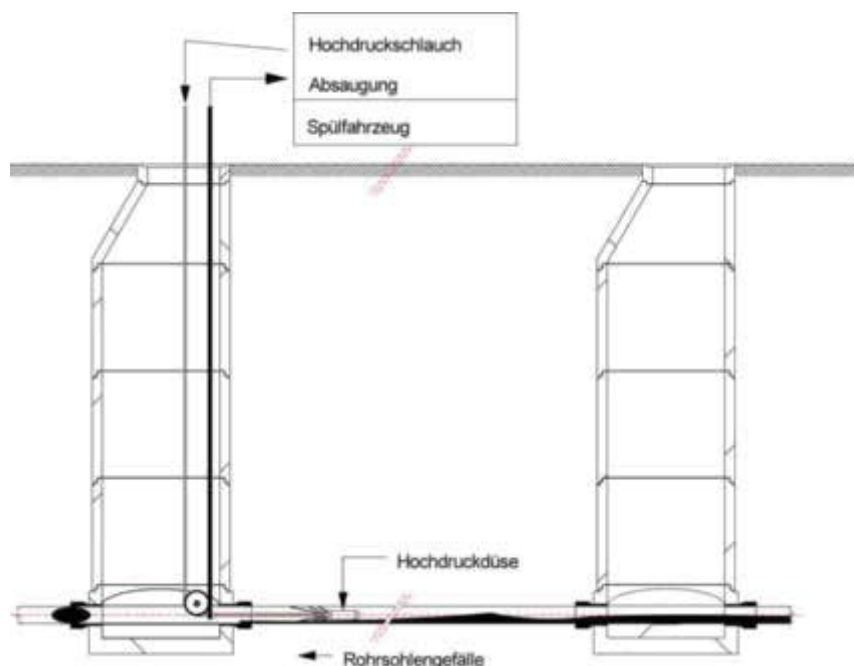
Einsatz einer Reinigung mit HD-Gerät
